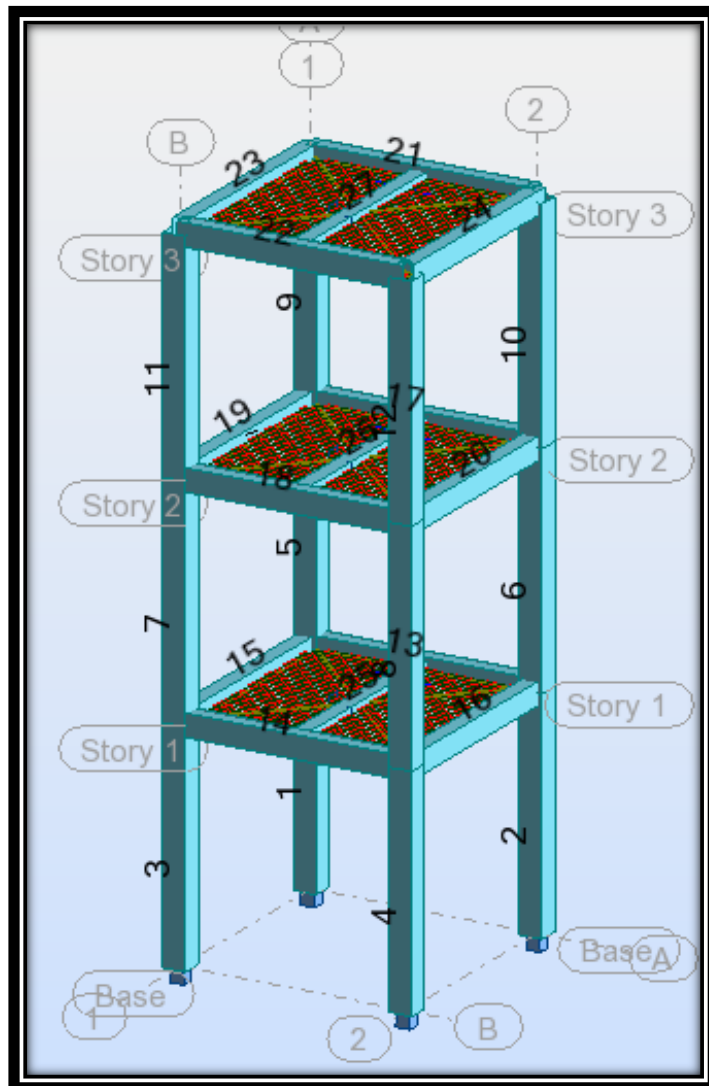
1 Modelo para Hormigón Armado de 3x3m.
